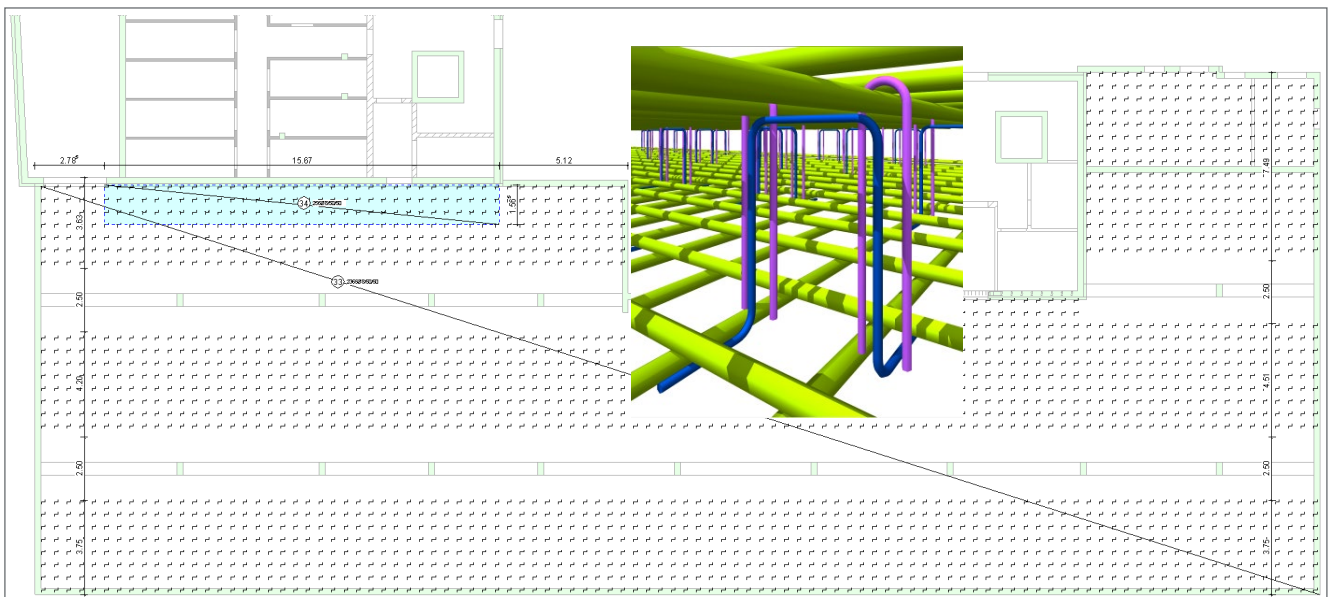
Verlegeplan Decke mit Schubbügel und Haarnadeln
